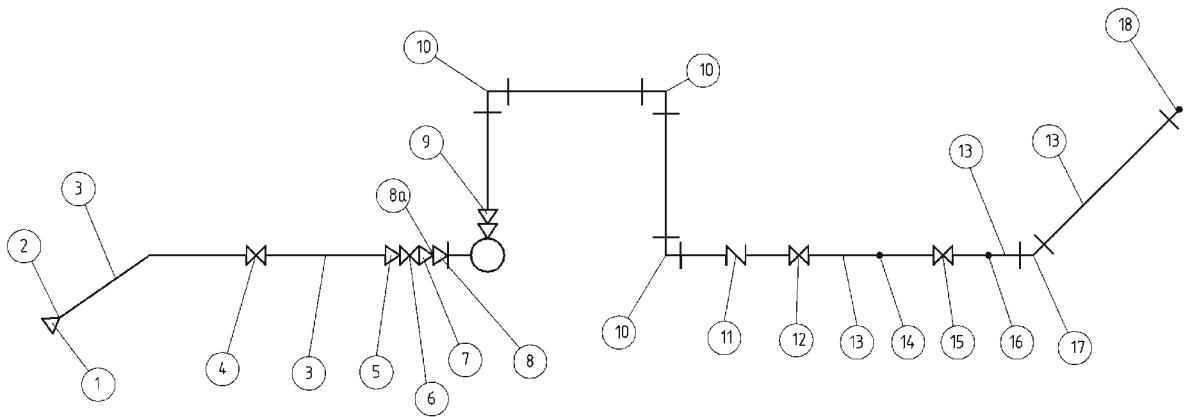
Разрез по оси водовода, подающего воду на орошение
